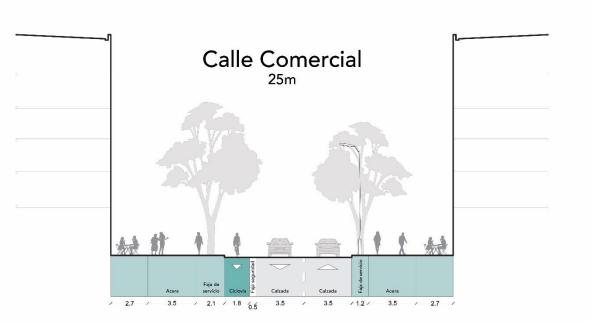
Guía de diseño para Ejes comerciales (Perfil vial: 25 m)
